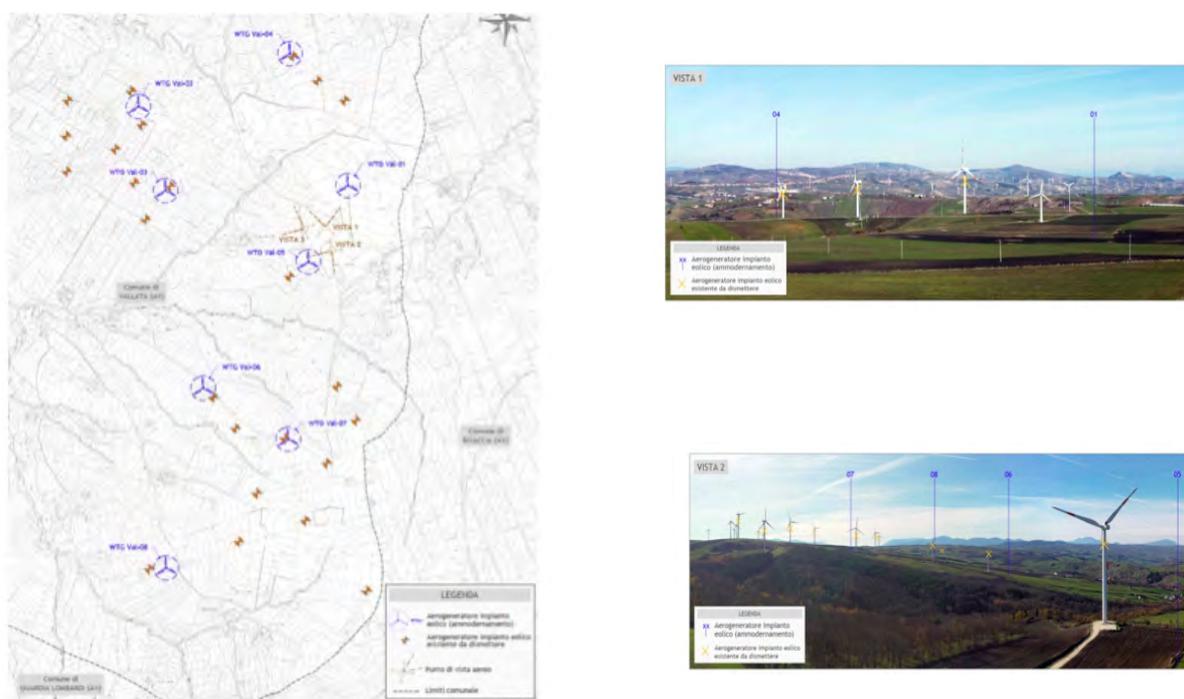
Quadro d'unione e vista aerea dell'impianto esistente. Stralcio della planimetria CTR con ubicazione punti di vista aerei per la documentazione fotografica attestante le condizioni del sito prima dell'intervento d'ammmodernamento
